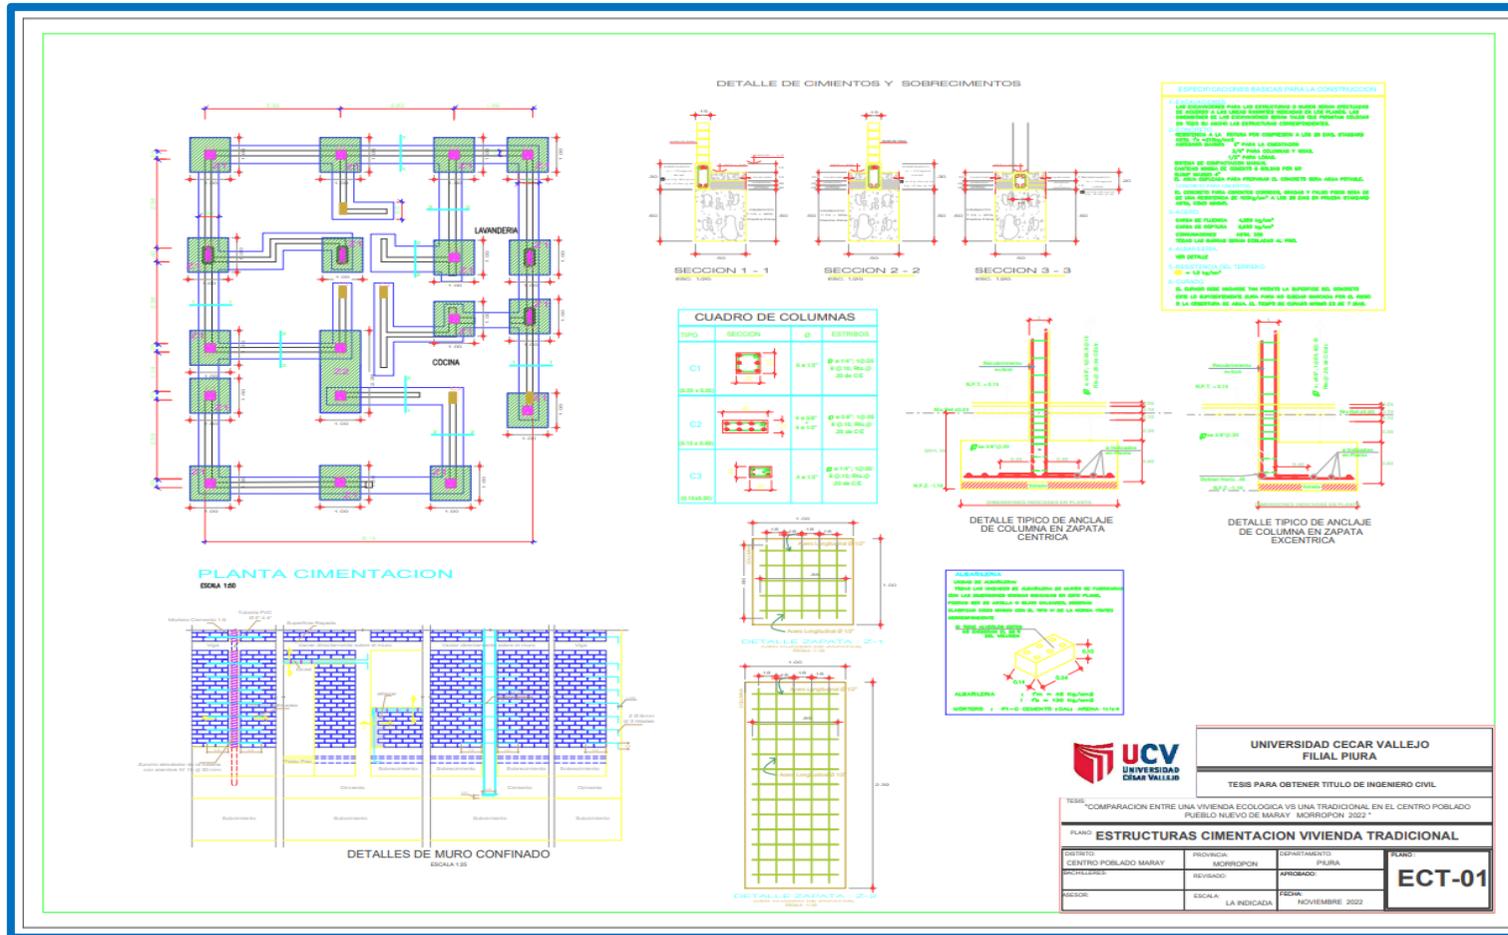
Plano de estructuras, cimentación – vivienda tradicional (ECT – 01)
